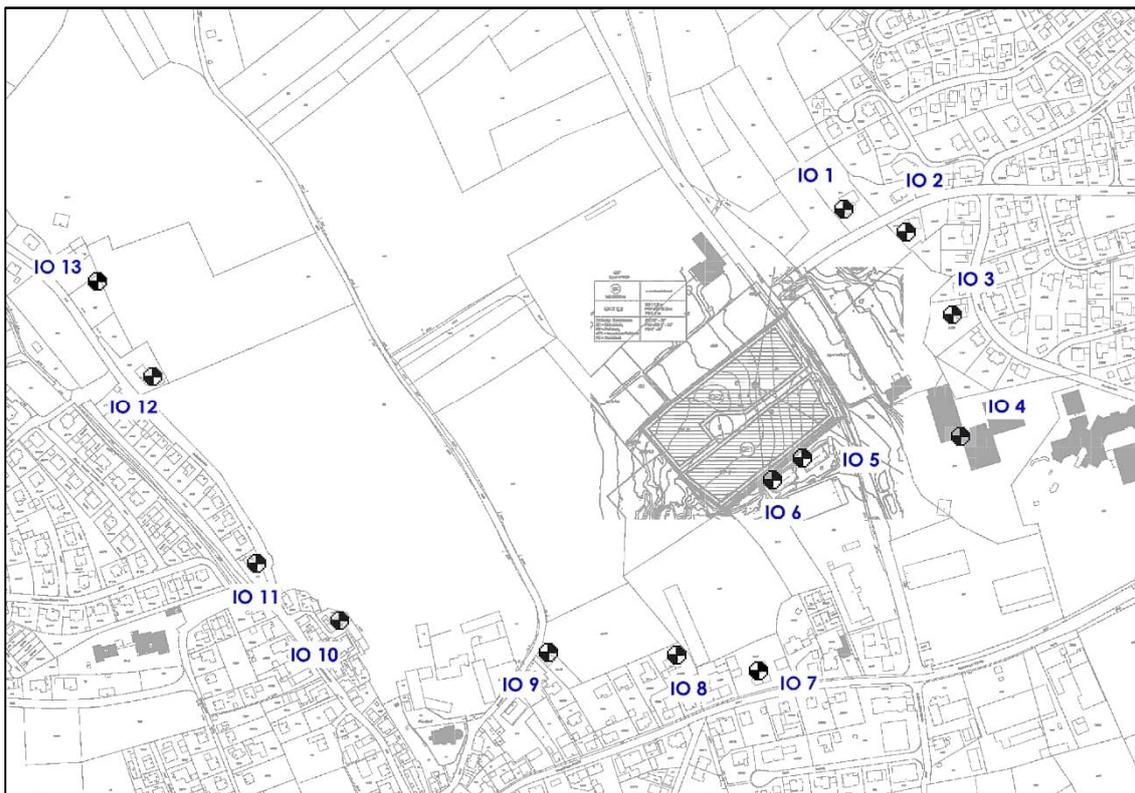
Lageplan mit Darstellung der maßgeblichen Immissionsorte IO 1 bis IO 13
